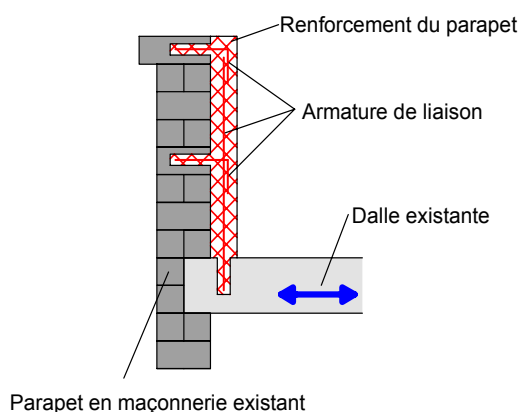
> Consolidation postérieure d'un parapet en maçonnerie par du béton armé
